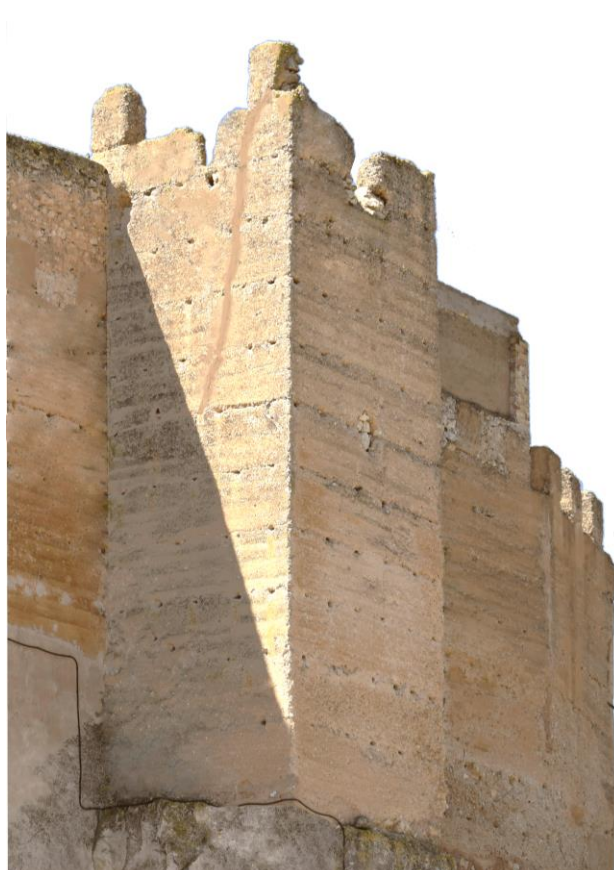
Vista de la torre D restaurada. Fuente: Autora.
